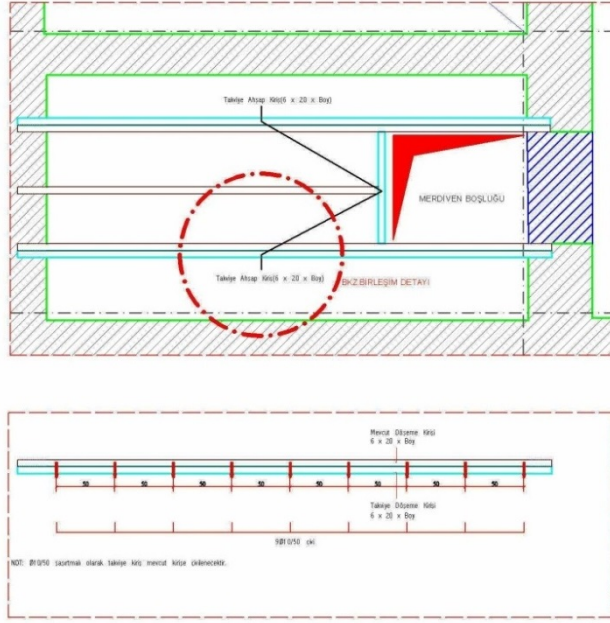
3-3 kesiti ölçek: 1/50
